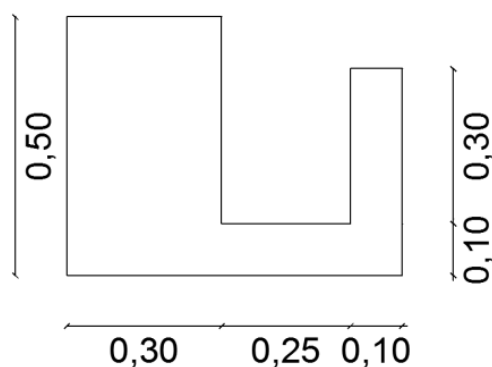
Secção transversal da viga V4, dimensões em metros
